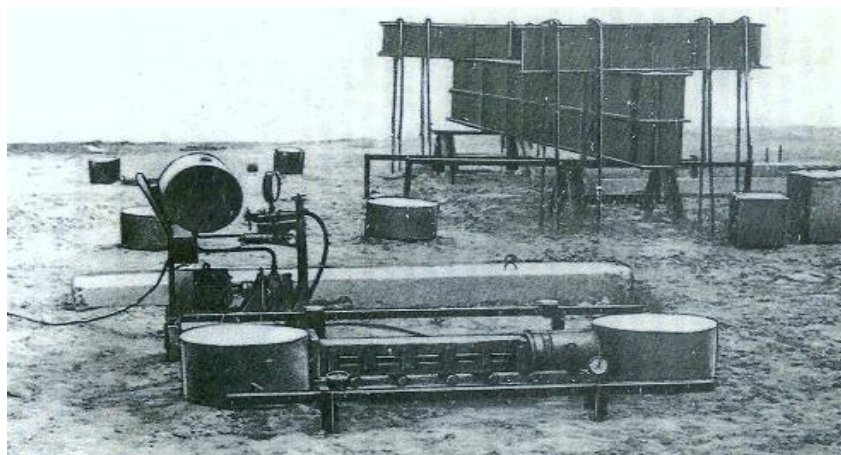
Экспериментальный полигон по испытанию свай разными видами нагрузок
